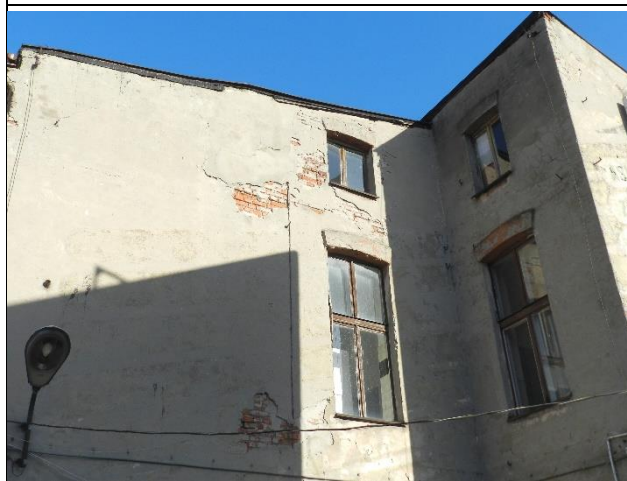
Widok ściany szczytowej – elewacja północna – widok wtórnej stolarki okiennej
